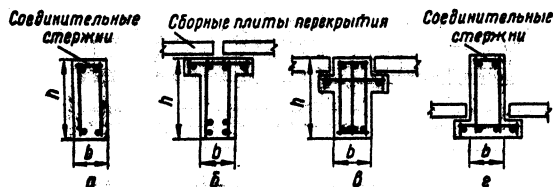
Поперечные сечения балок и схемы армирования их плоскими сварными каркасами:
